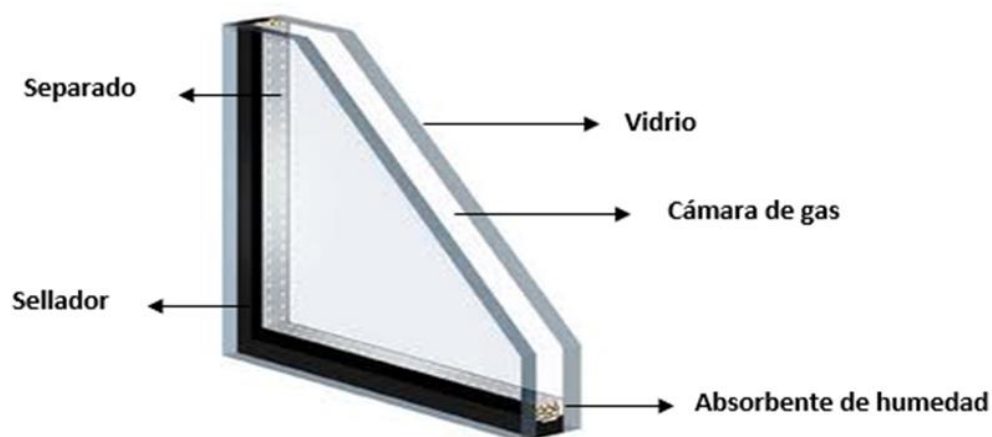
Esquema constructivo de un DVH. - Fuente: Manual del Vidrio Plano 4ta edición.
